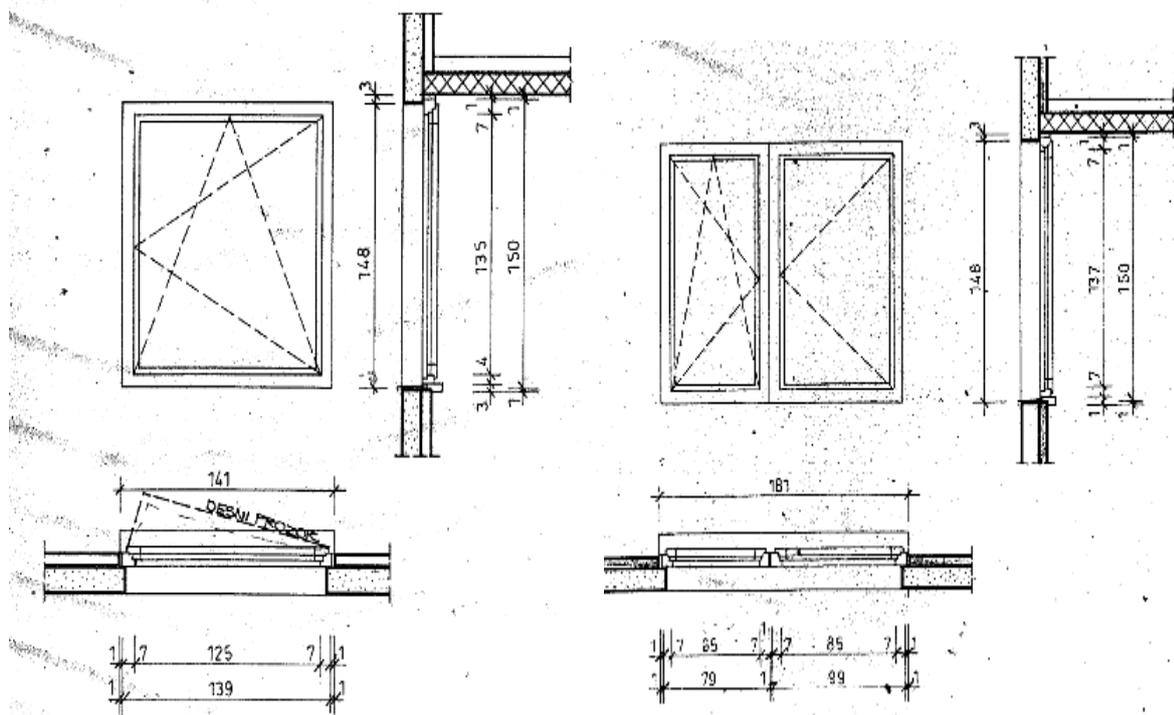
Fensterabmessungen- und Einbau (Fa. DOM Sarajevo)
